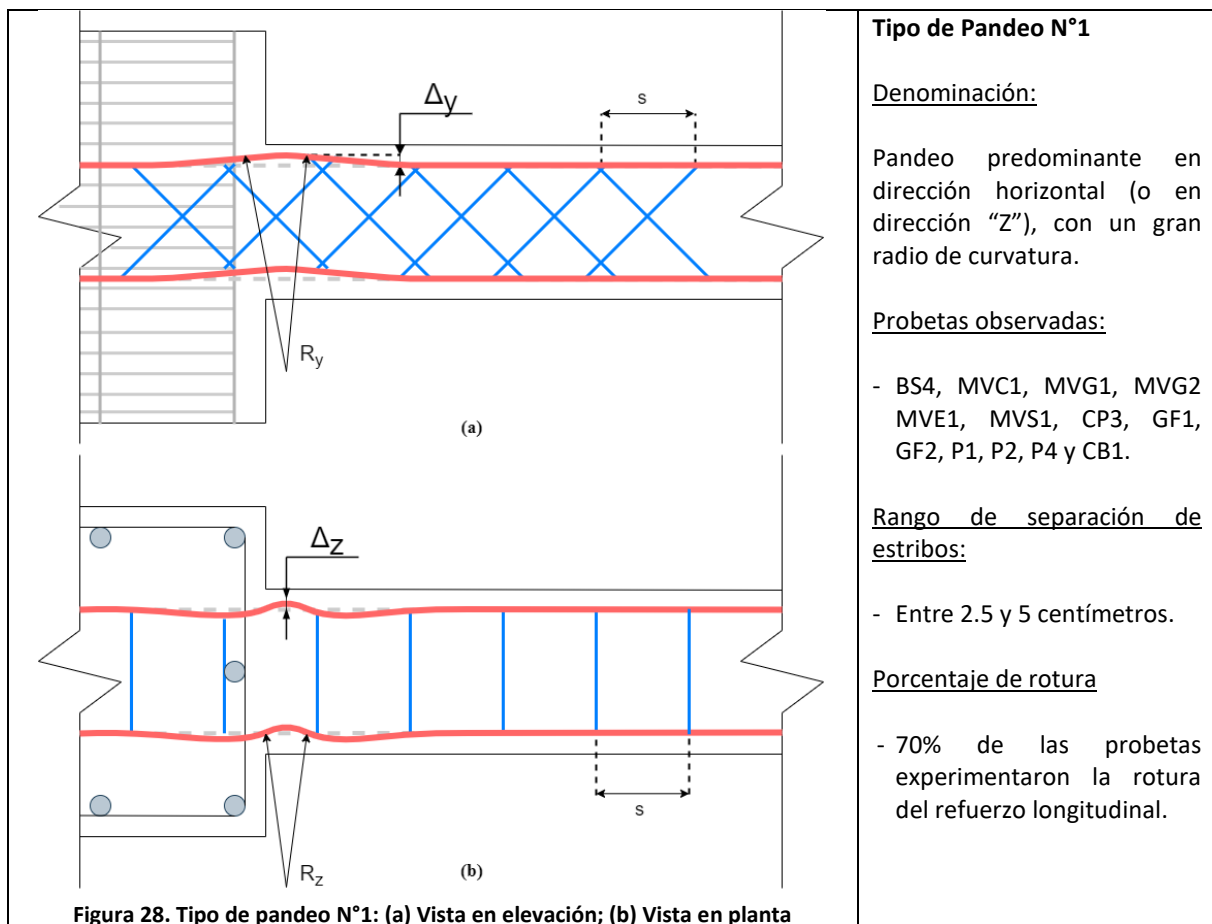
Tipo de pandeo N°1: (a) Vista en elevación; (b) Vista en planta
